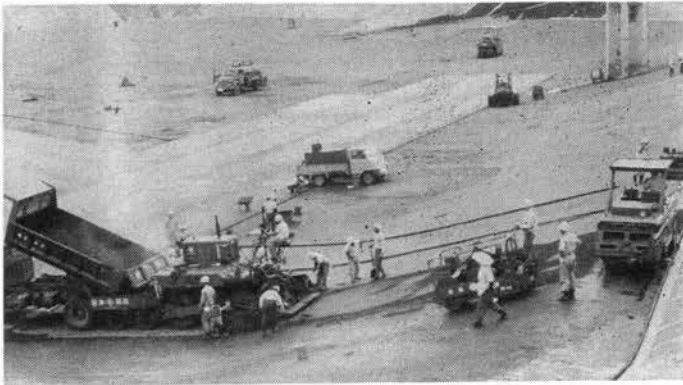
下和田貯水池の1:4のり面と底面の機械化施工例
